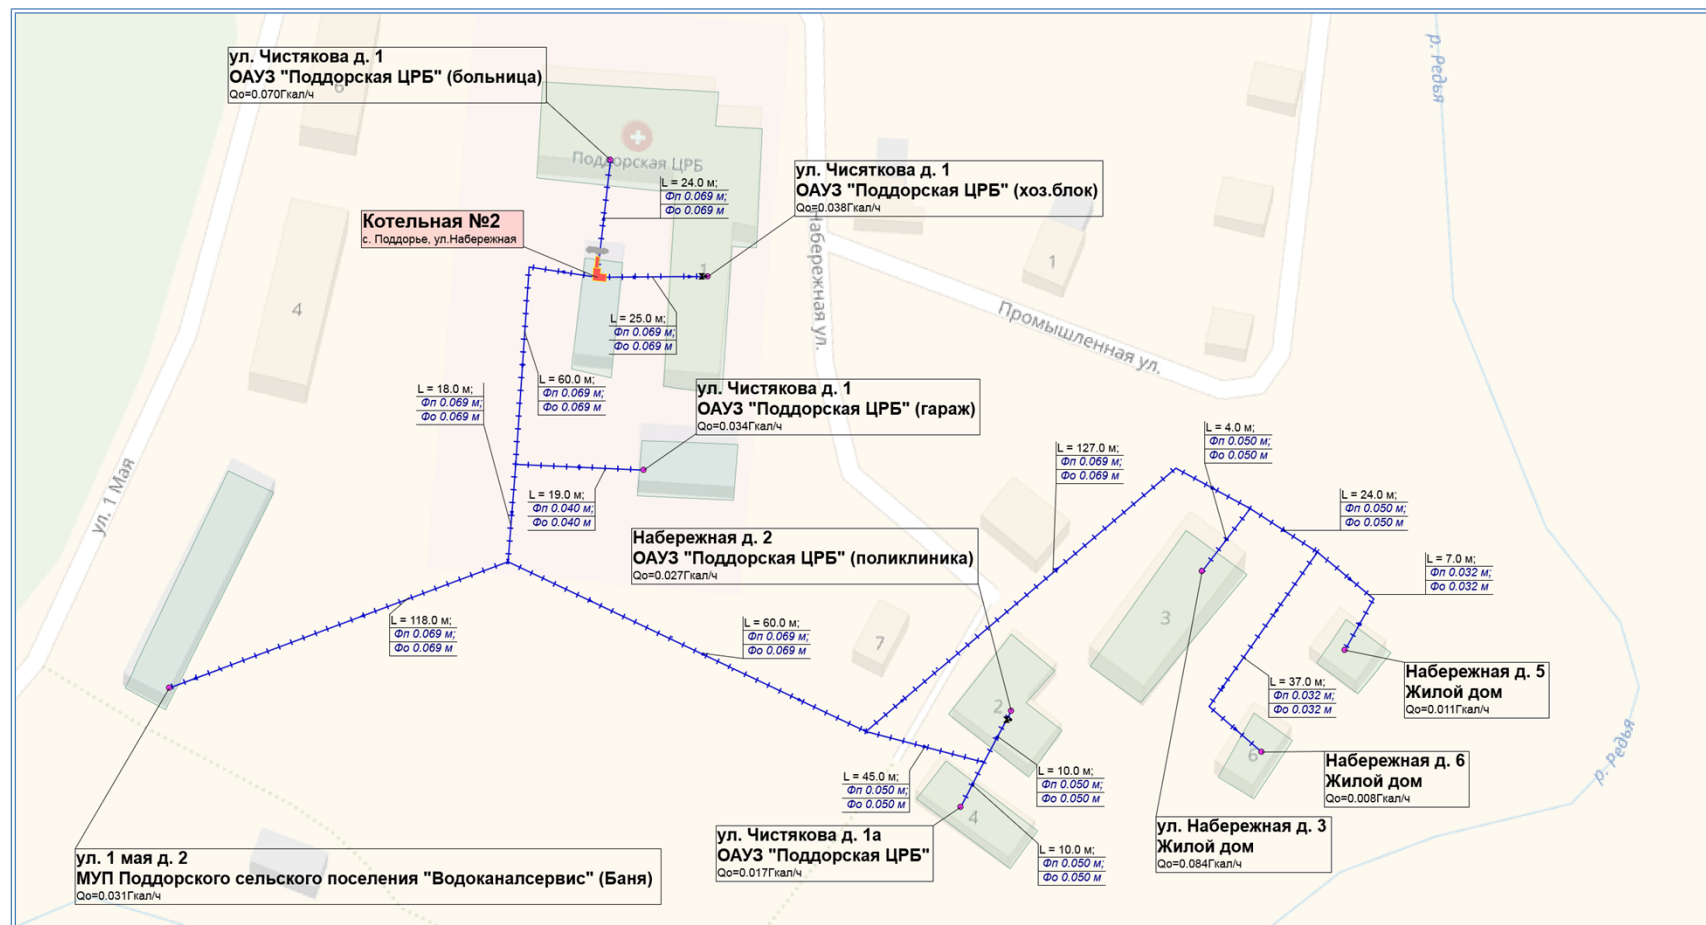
Схема тепловых сетей Котельной № 2, с. Поддорье ул. Набережная
